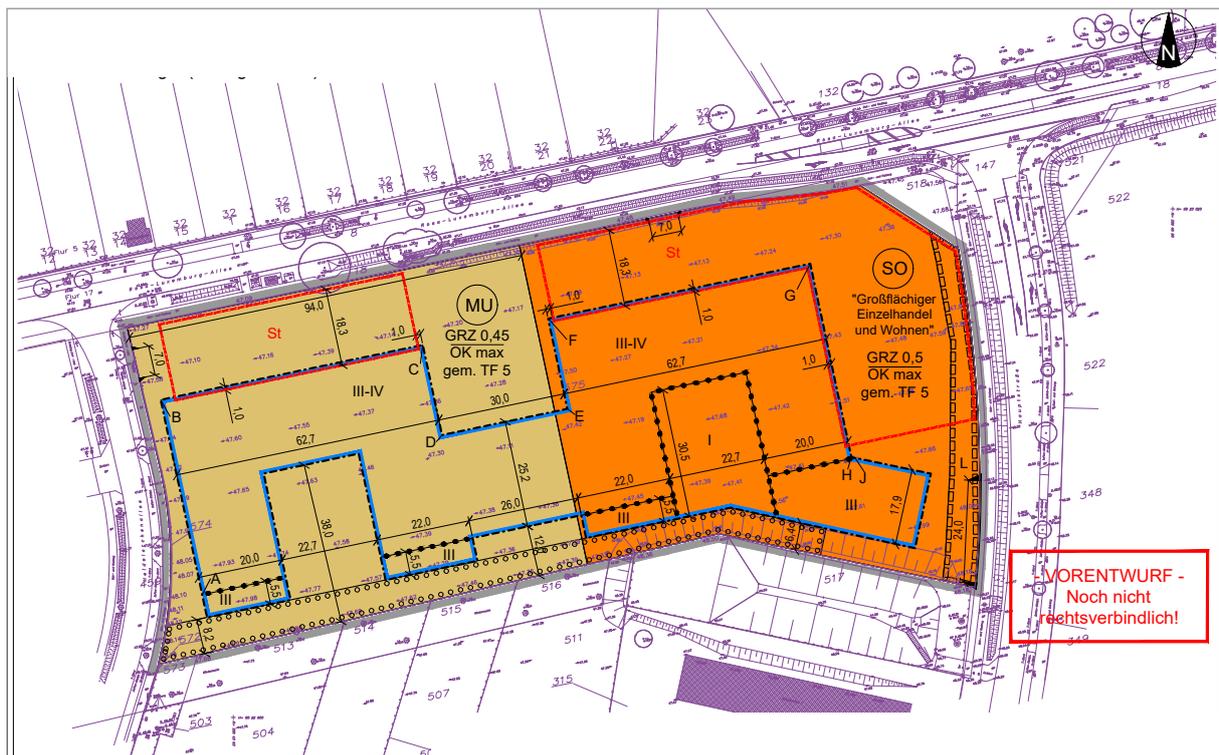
Planzeichnung des Vorentwurfs vom Bebauungsplan E 44, Plan und Recht GmbH
